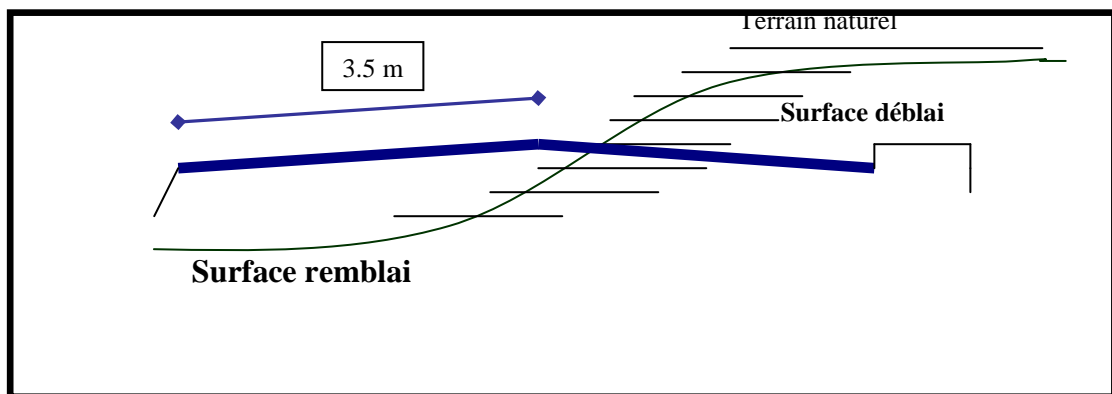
Coupe transversale d'une chaussée. [10]
